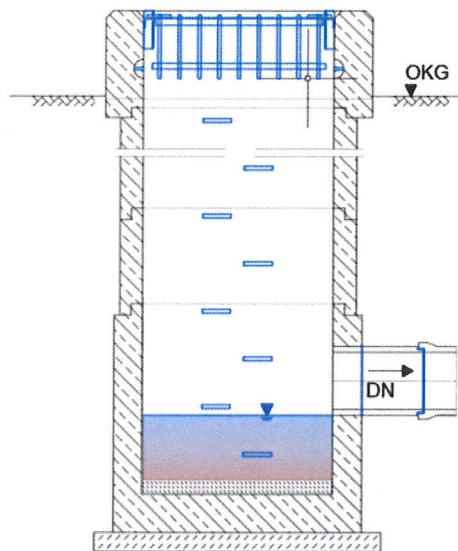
Systemdarstellung Einlaufschacht mit Schlammfang
